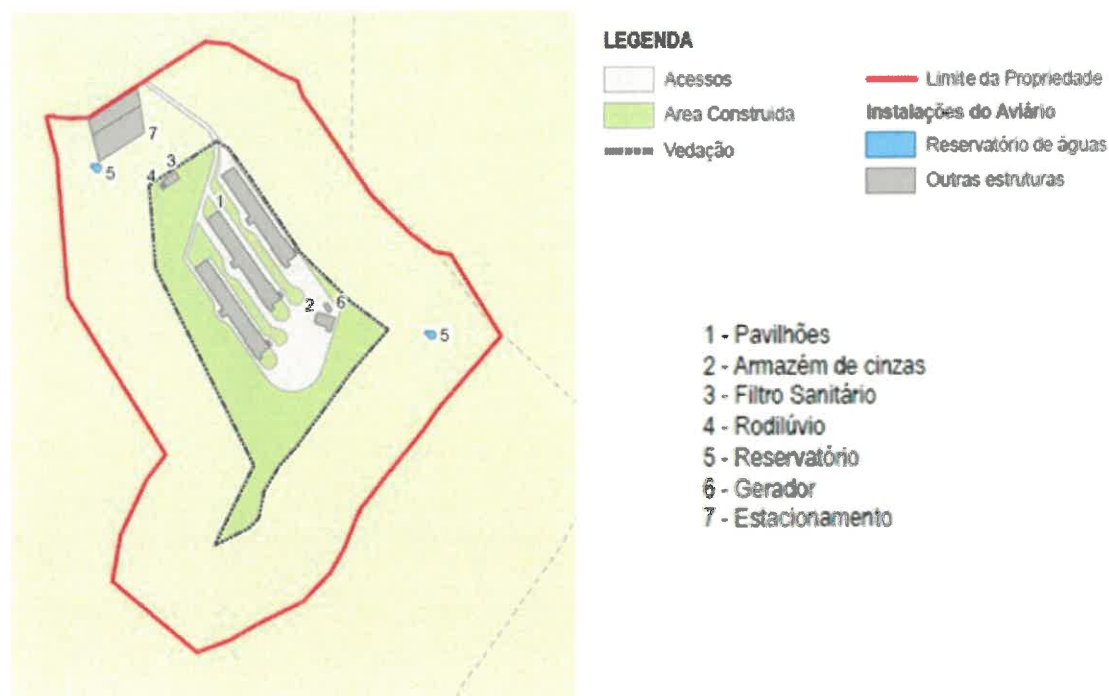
Planta de implantação da exploração na área da propriedade (fonte: EIA)
